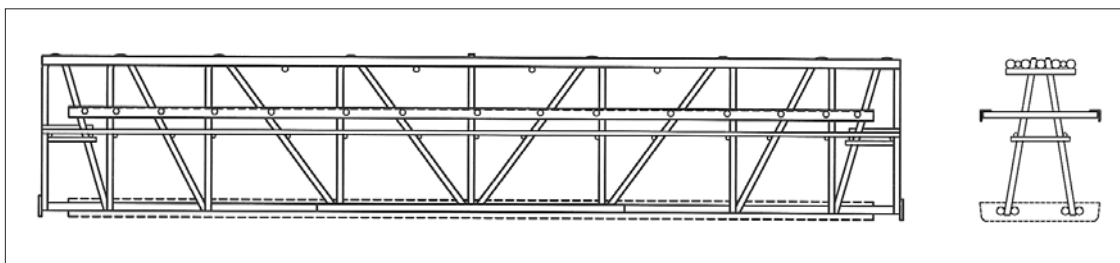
Vista laterale e sezione trasversale trave con fondello in cls.
